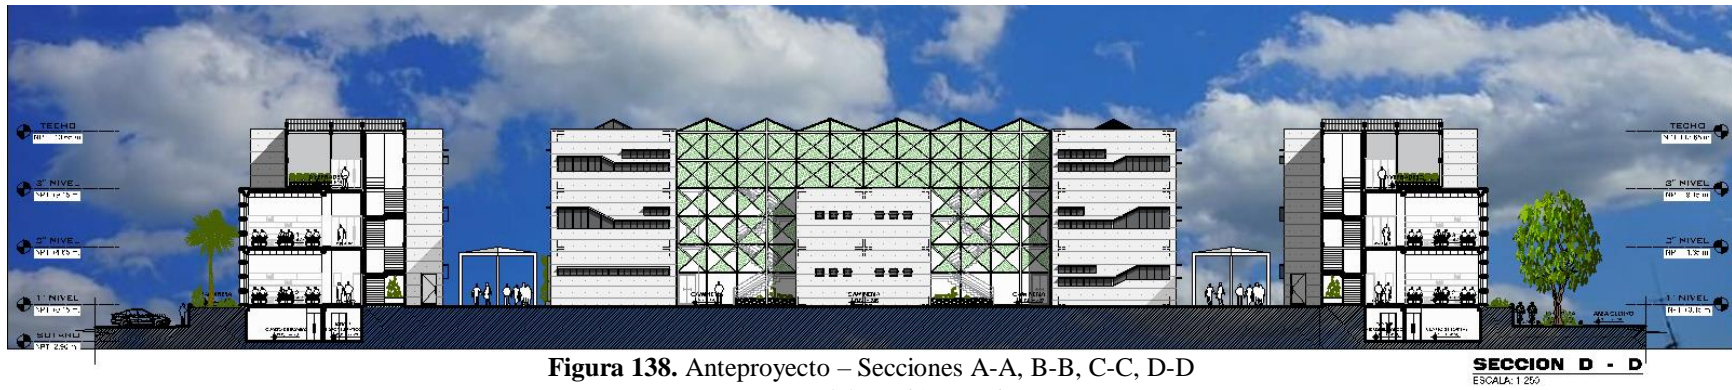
Anteproyecto – Secciones A-A, B-B, C-C, D-D
